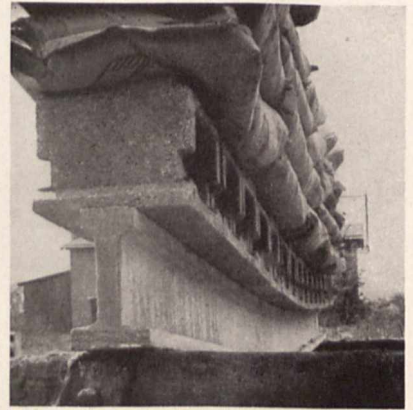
Belastungsversuch eines Stahlsaitenbetonträgers. — Die Träger sind weitgehend elastisch
